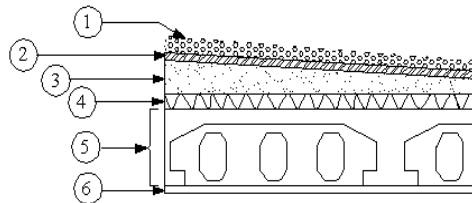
Coupe du plancher terrasse inaccessible (corps creux).
